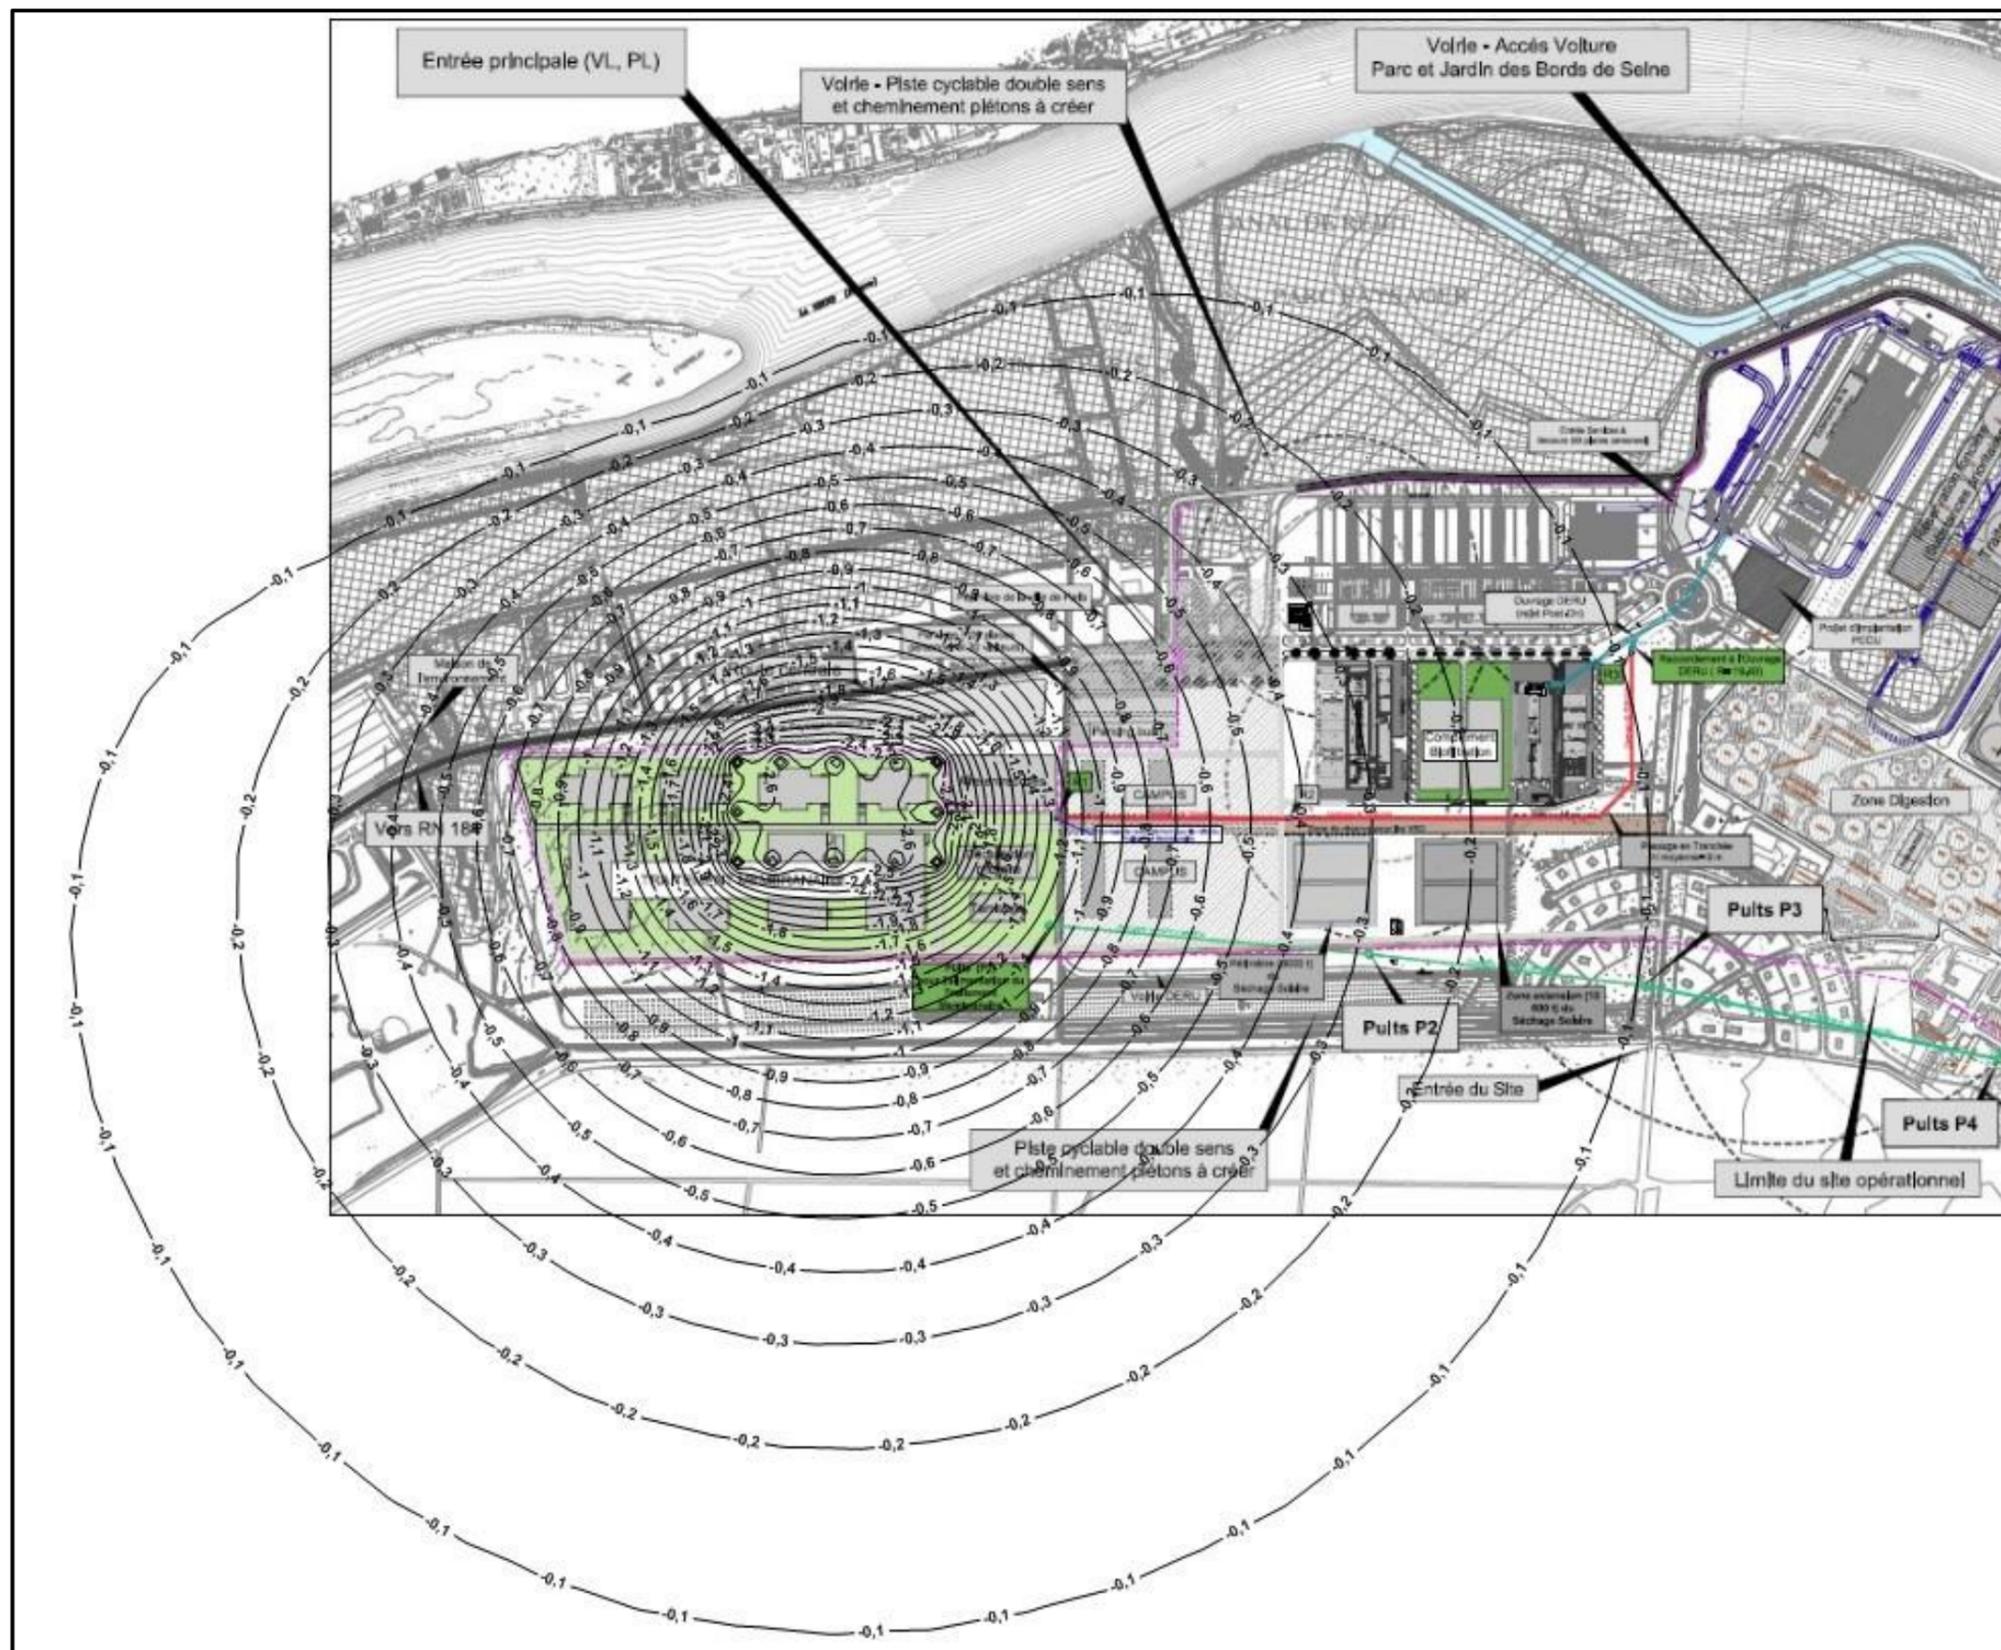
Modélisation du rabattement de nappe à l'objectif 18.5m NGF projeté sur le plan aérien du futur ouvrage.
